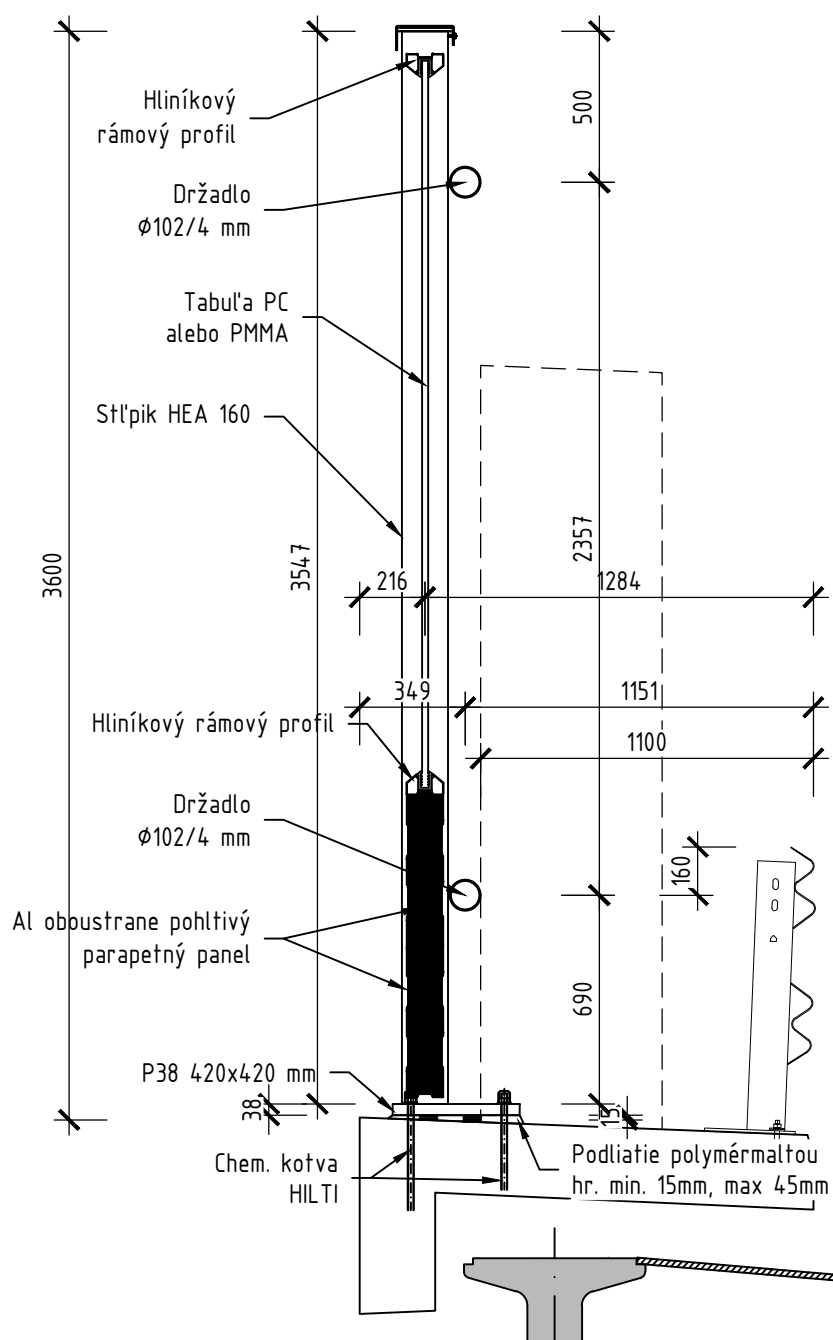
DETAIL ULOŽENIA VYSOKOABSORBČNÝCH
